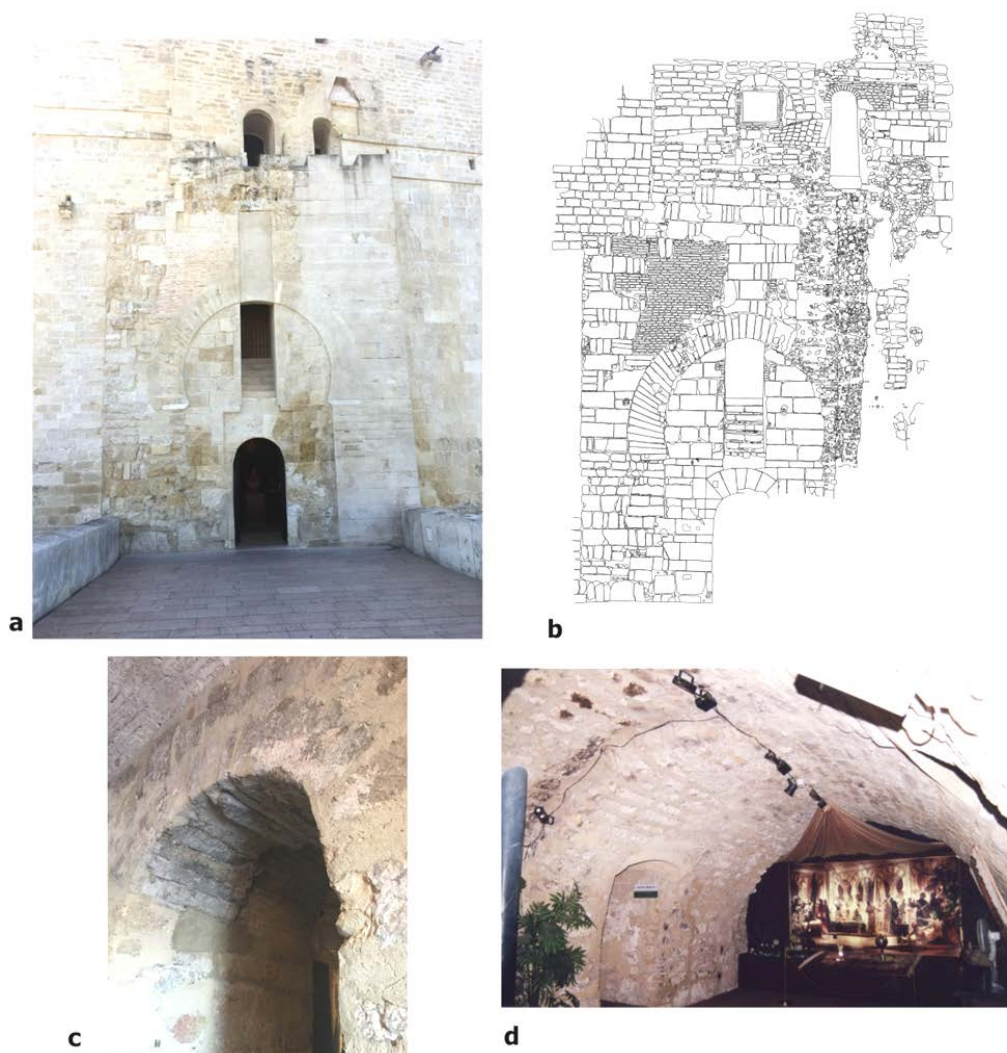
Estructuras conservadas pertenecientes a la puerta omeya: a.- Arco de la fachada norte; b.- dibujo del alzado del arco antes de la restauración (Copyright Convenio GMU-UCO); c.- detalle de las dovelas de sillería del vano abiertos en el flanco occidental del pasillo de acceso; d.- intradós de la bóveda del arco conservada en el interior del primer piso de la torre.
